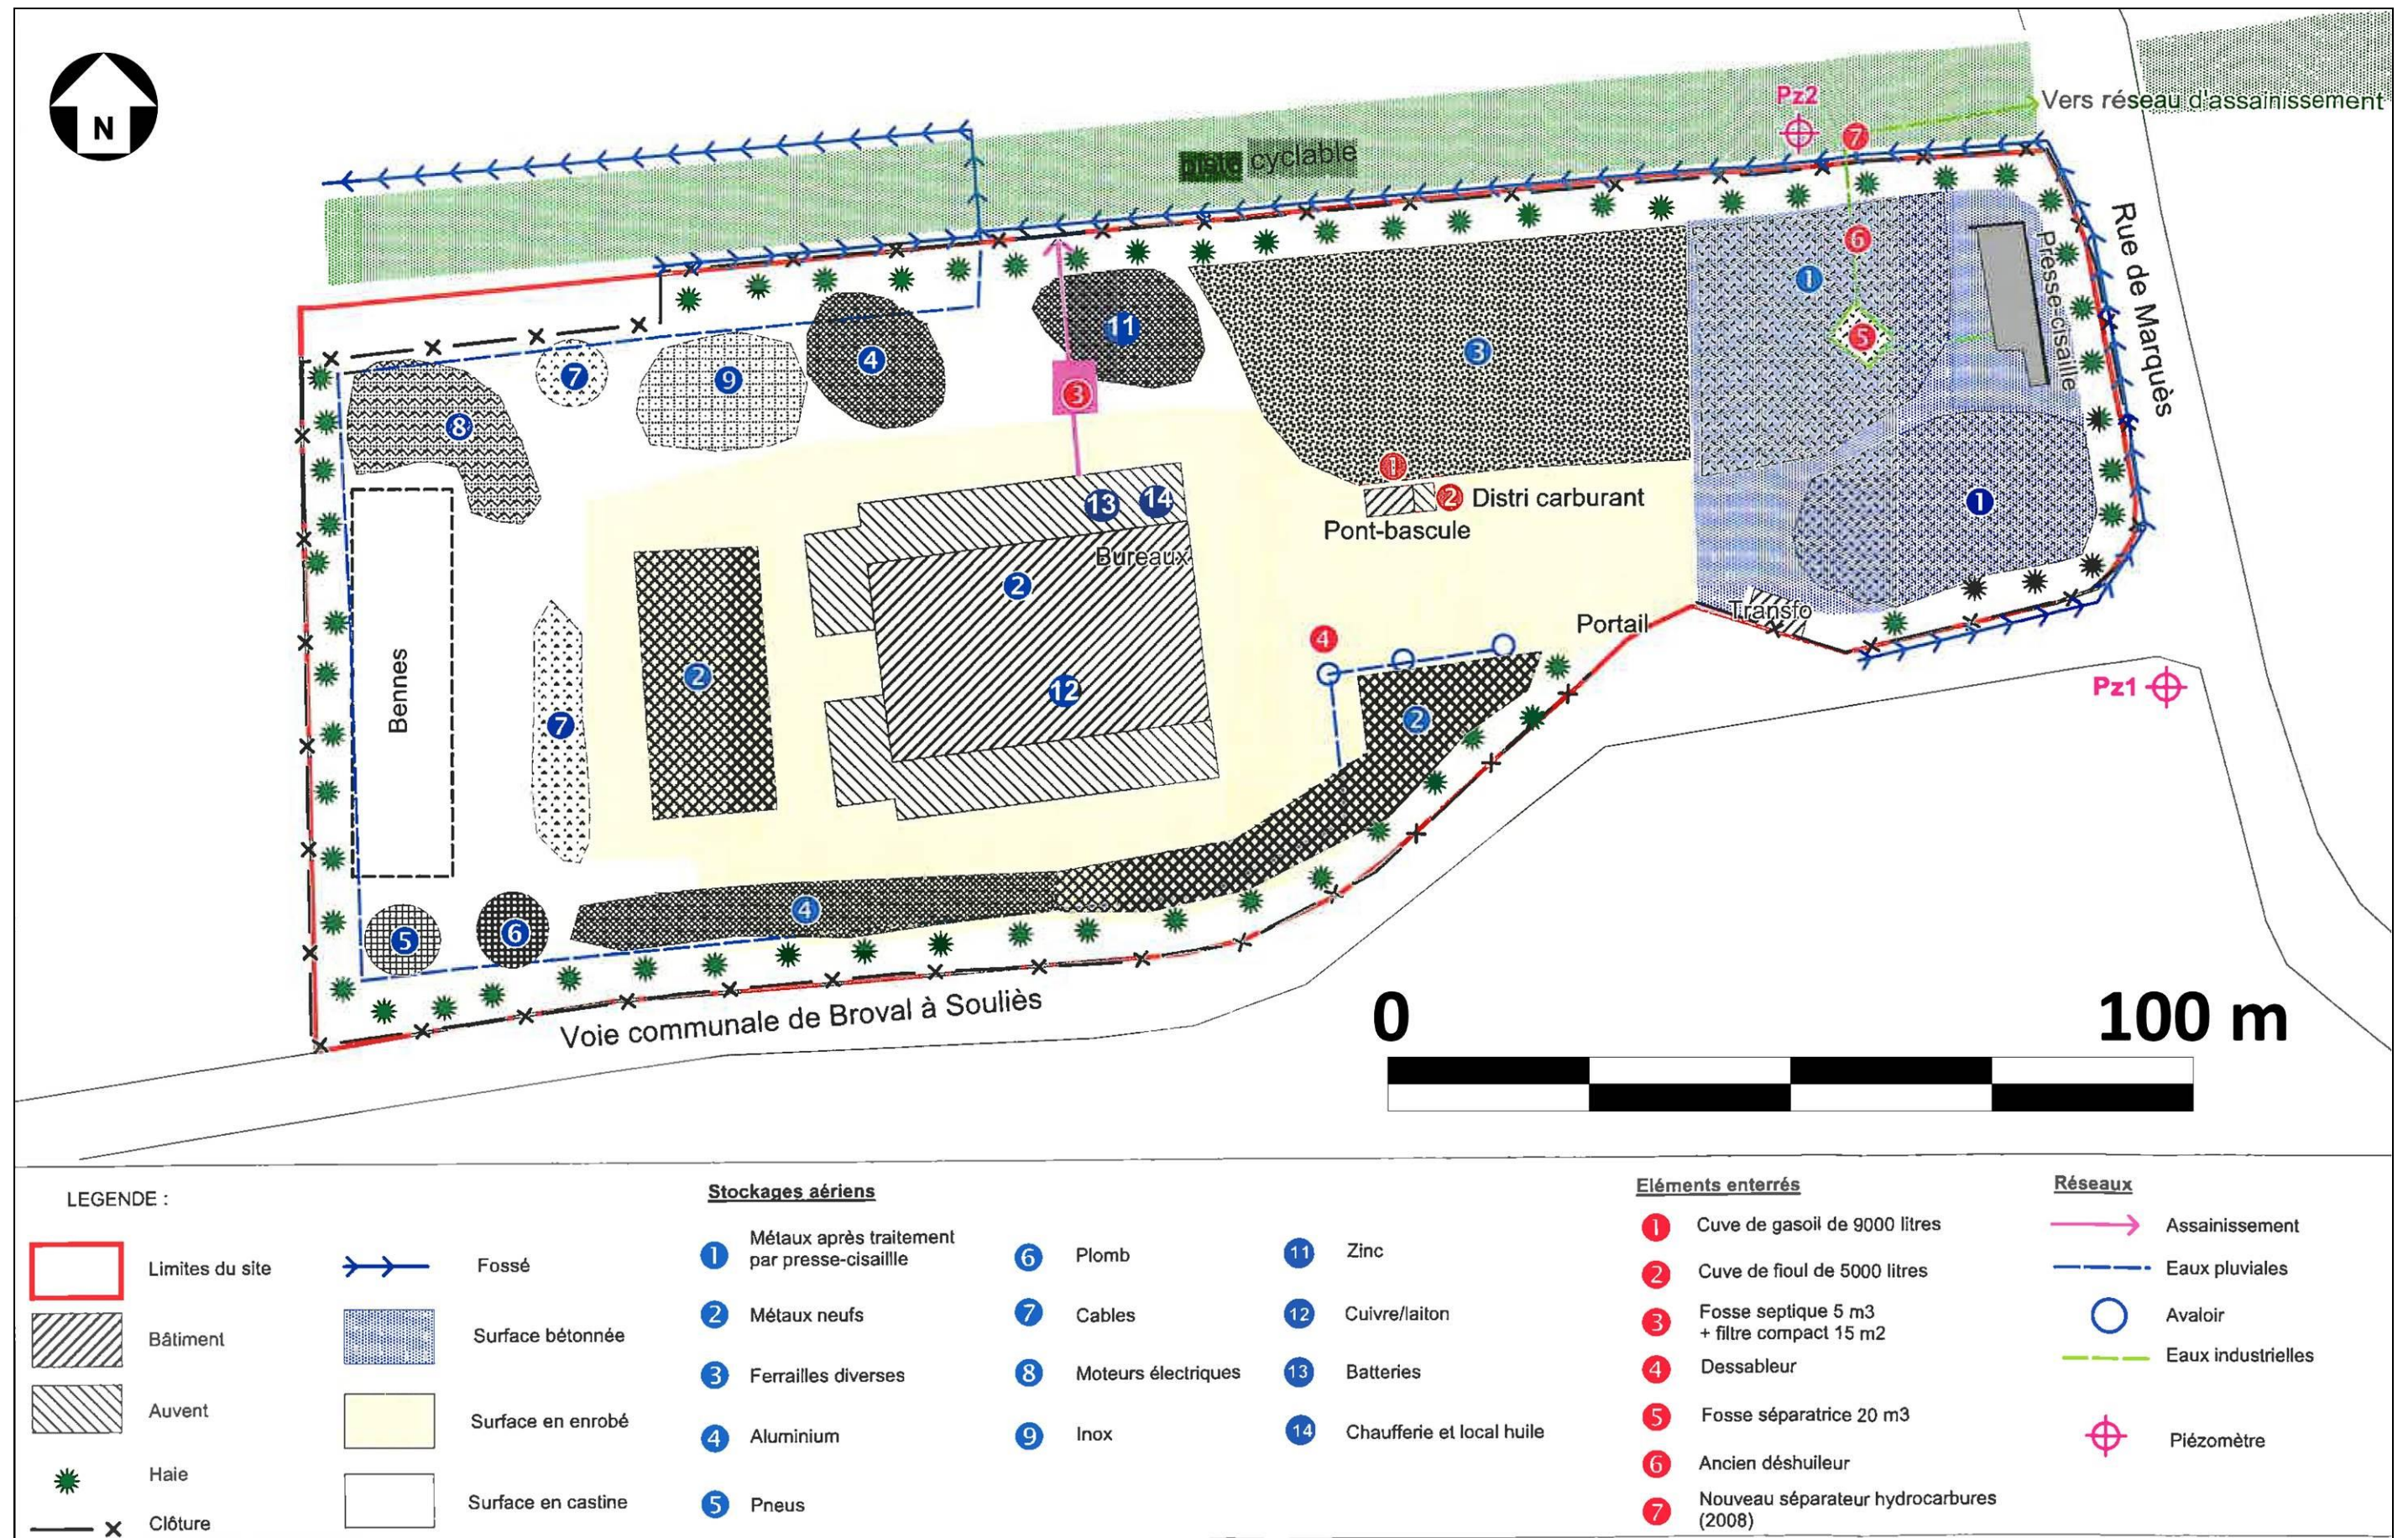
Plan de masse du site lors de son fonctionnement (en 2009)
